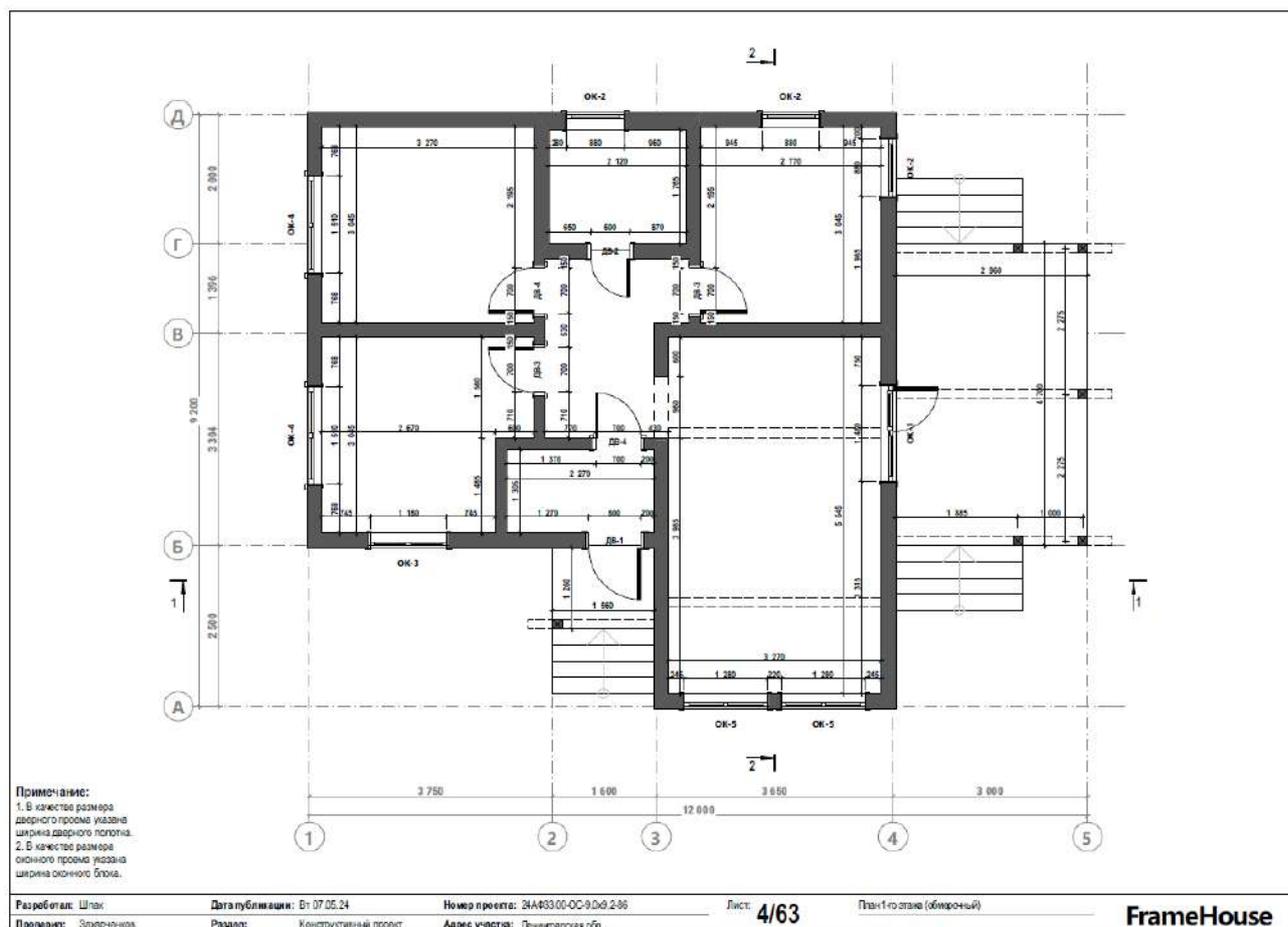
Обмерный план первого этажа индивидуального жилого дома
